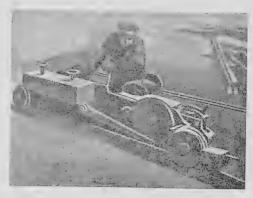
Электромоторный шлифовальный круг для рельсов.
